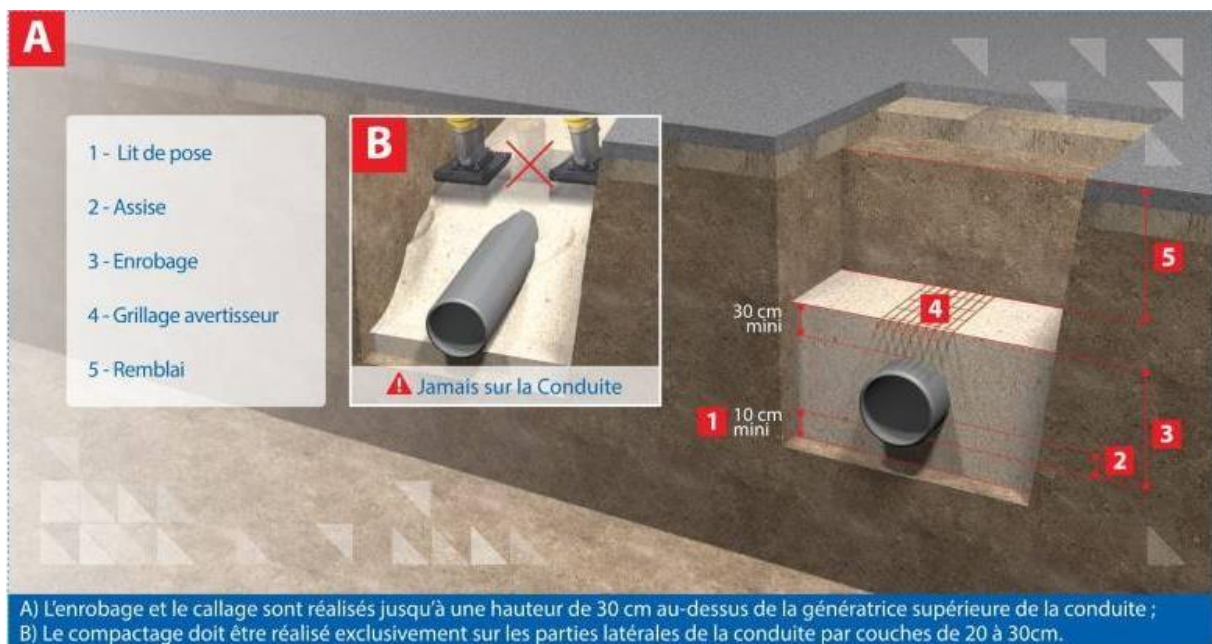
Remblaiement des canalisations (Source : Groupe Chiali)
